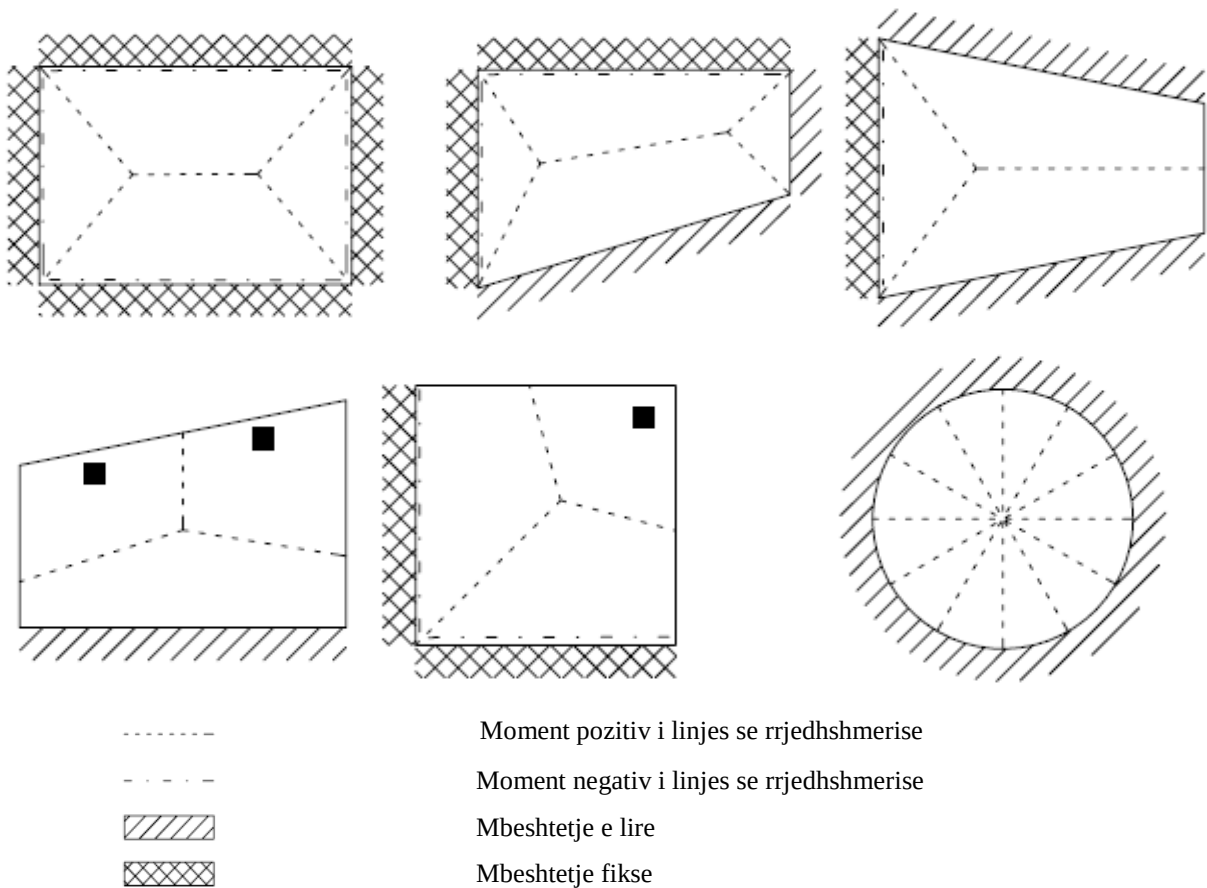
Disa shembuj të modeleve të vijave të rrjedhshmërisë [29]
